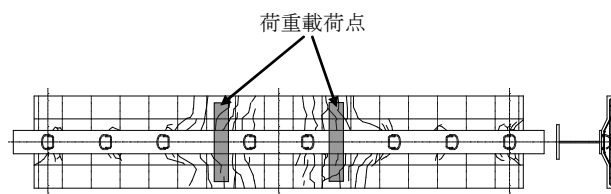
床版下面最終ひび割れ状況(普通コンクリート)
